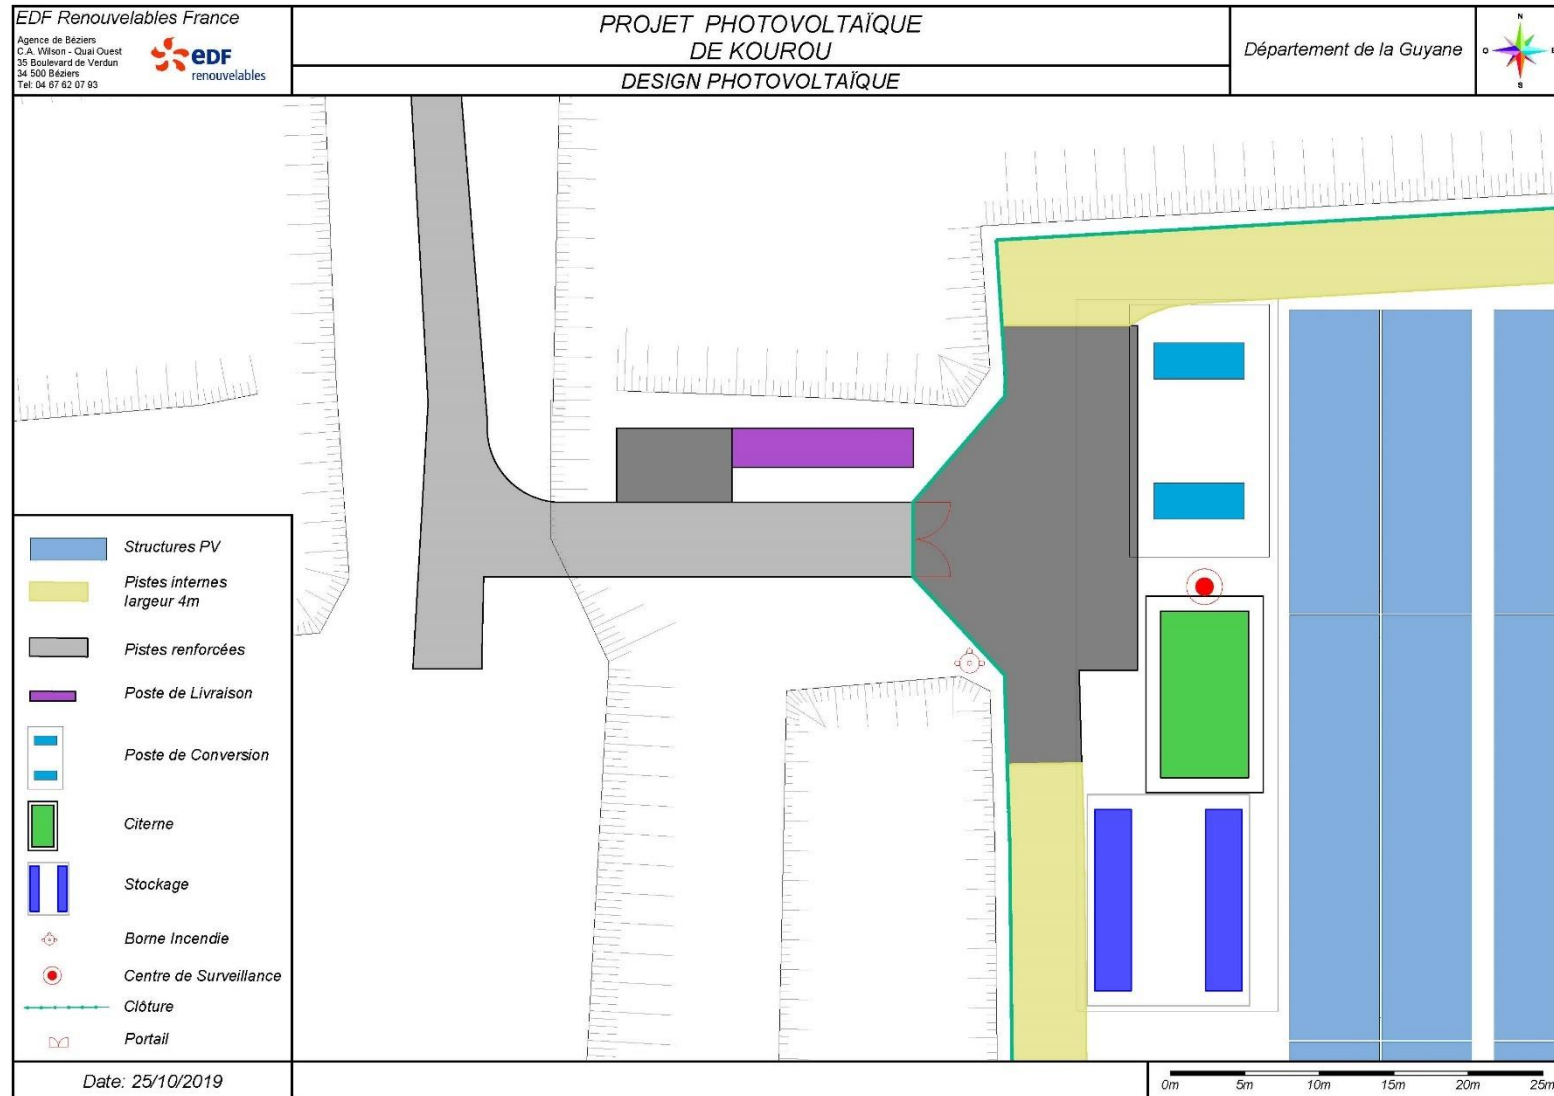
Plan du projet : zoom sur l'entrée de la centrale
